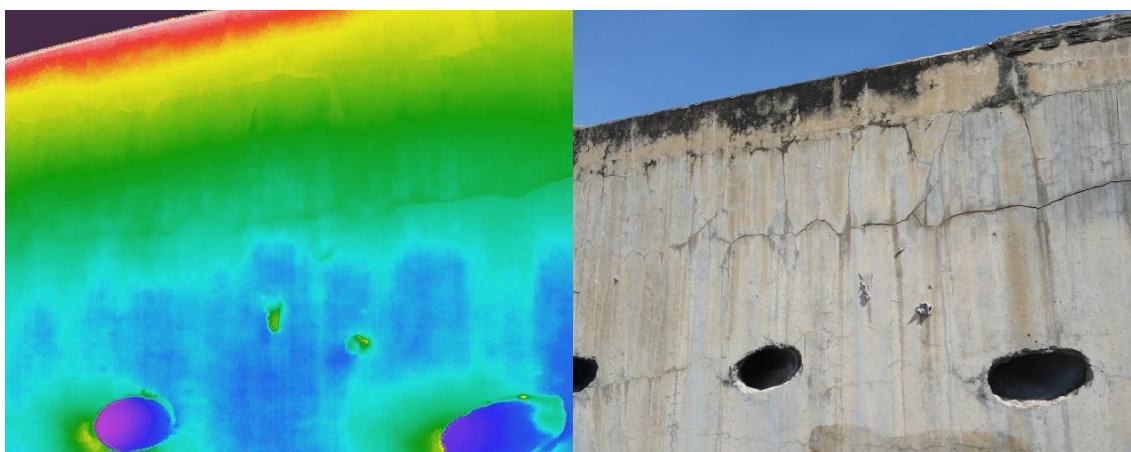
Teste com a câmera térmica em viga teste para verificação de fissuras
